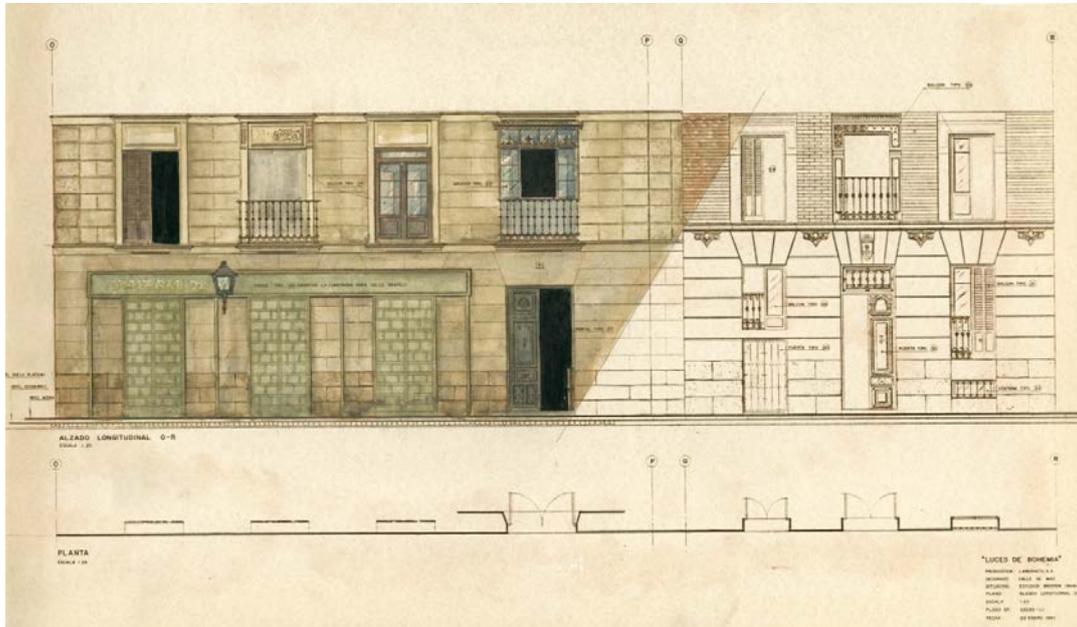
Dibujo técnico del alzado de fachada de la calle donde transcurre la escena anterior. Plano a tinta y acuarela sobre papel. DIN-A3.
